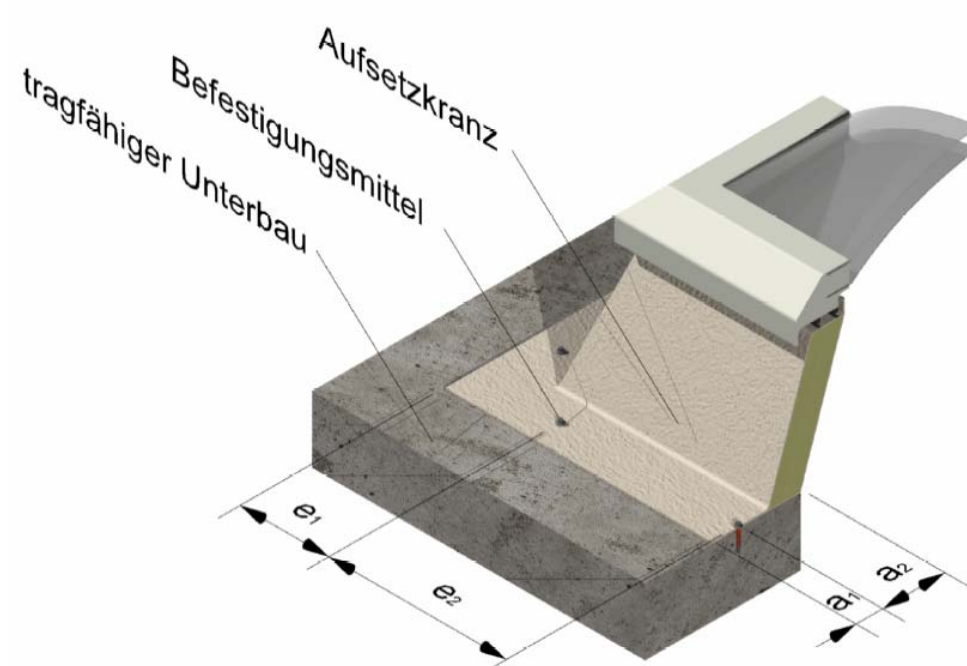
Mindestabstände zur Befestigung am Aufsetzkranzflansch
